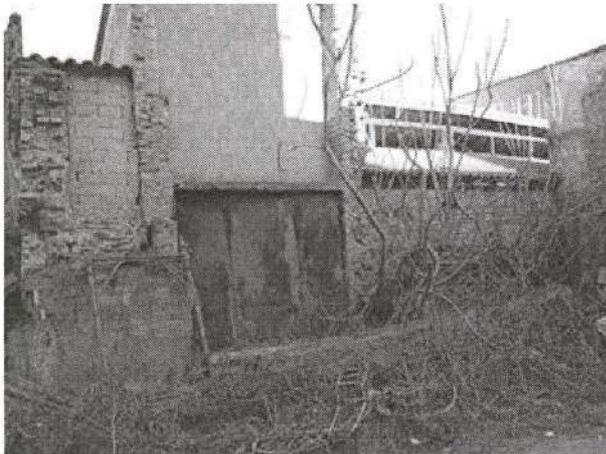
FOTO PARETI PERIMETRALI IN ADERENZA CON IL VECCHIO
